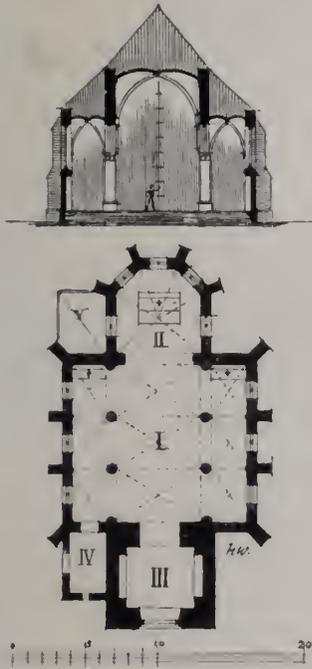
Boisheim. Grundriss und Durchschnitt der Pfarrkirche.
